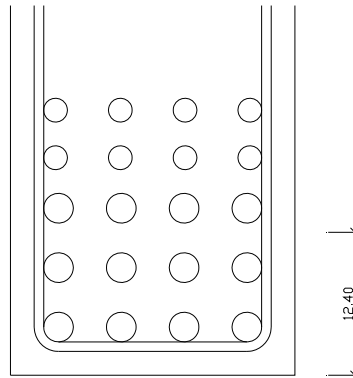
Detalle de disposición de armaduras en viga exterior.
